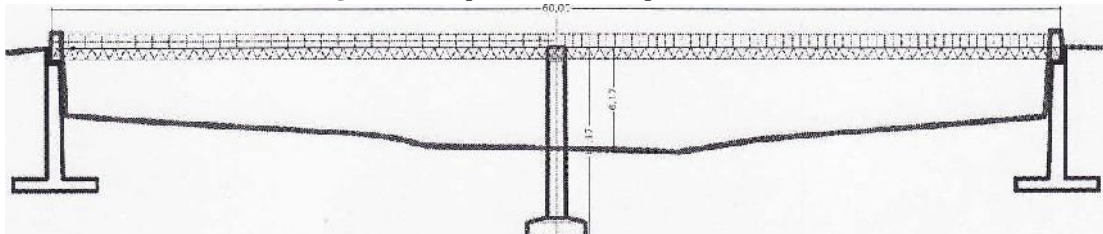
Esquema del Puente peatonal Perfil Longitudinal
